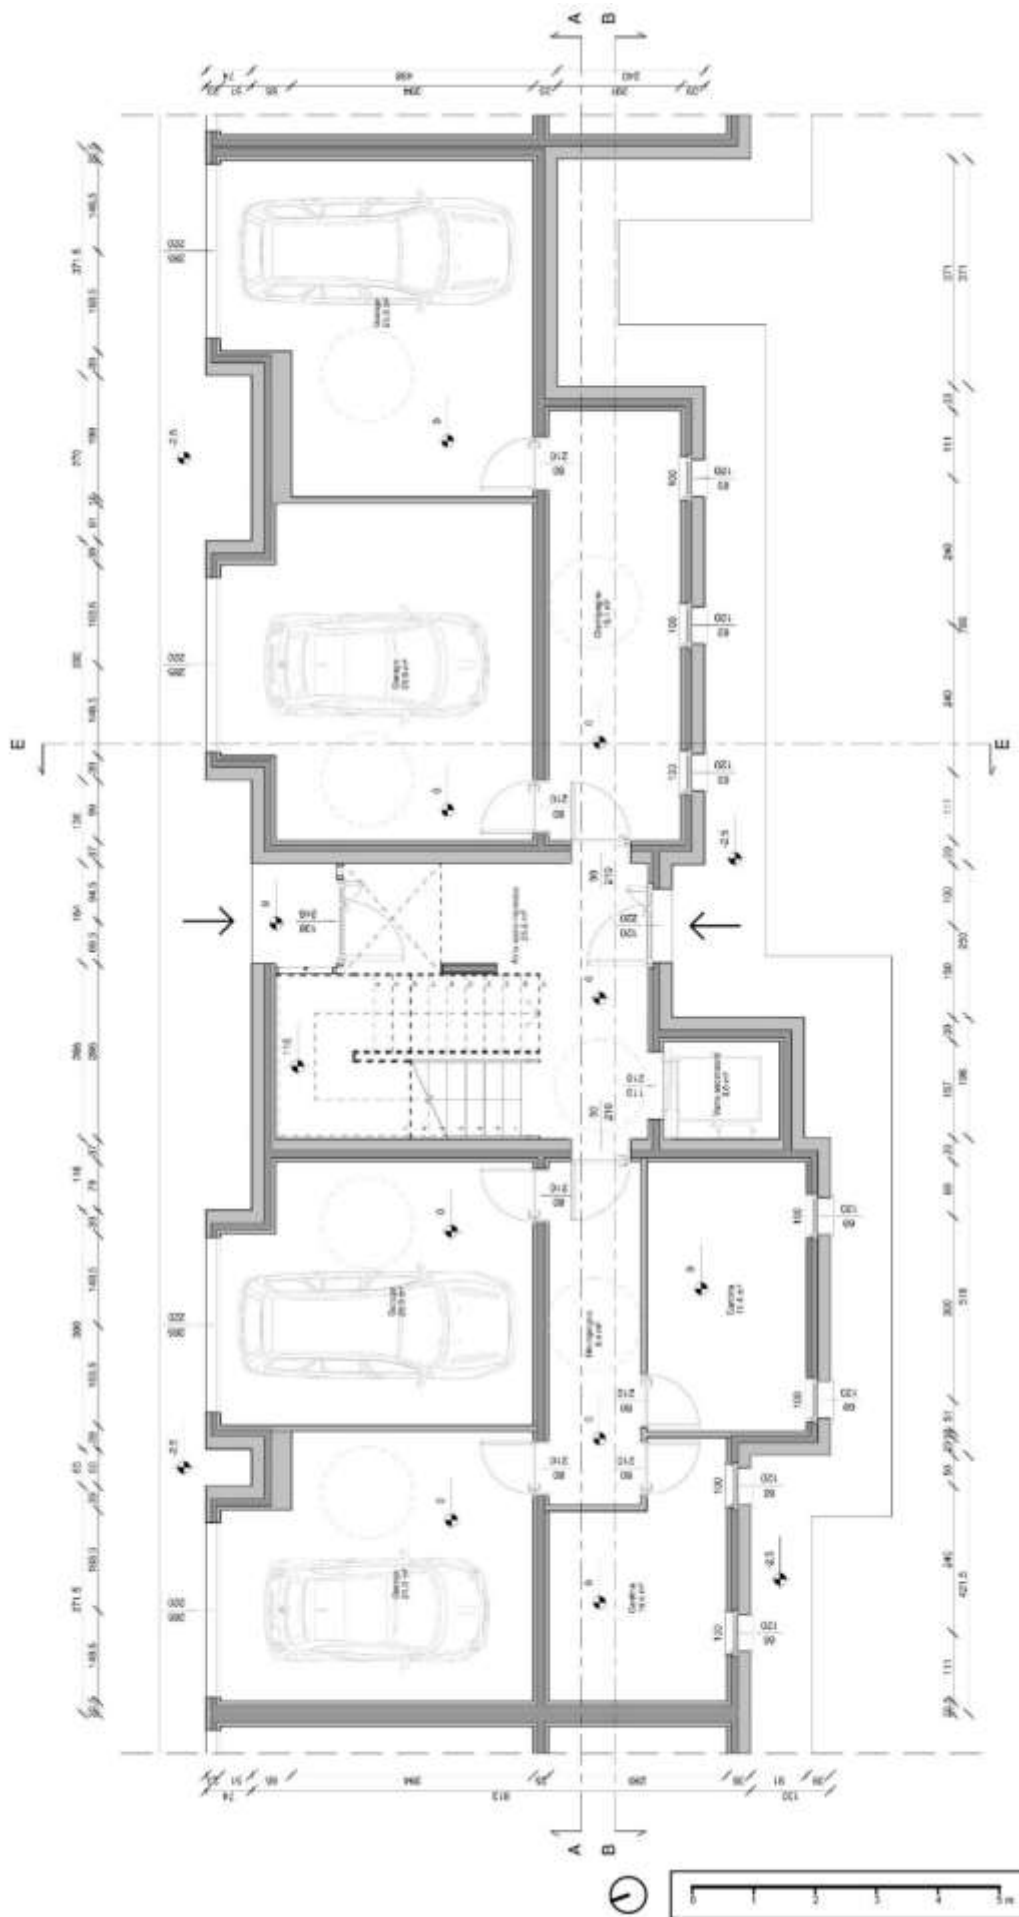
Pianta P00 del Blocco C. [Fonte: elaborazione dell'autore]
